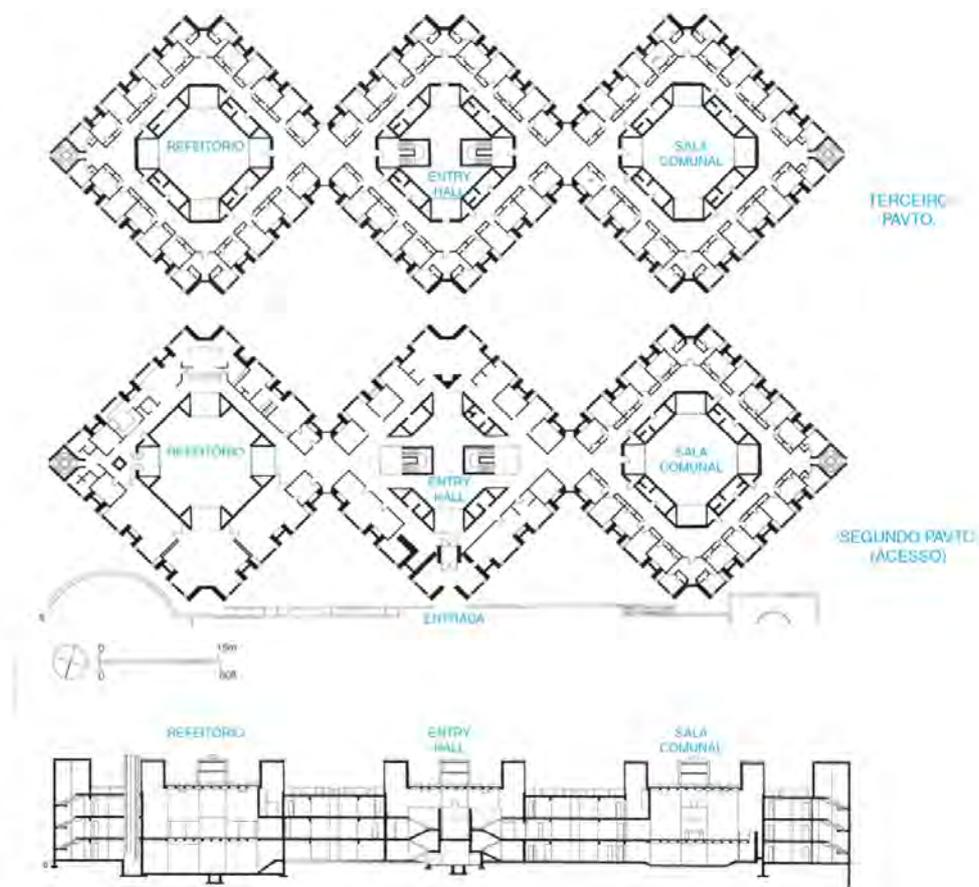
| Planta e corte Edrman Hall Dormitory [McCARTER]
